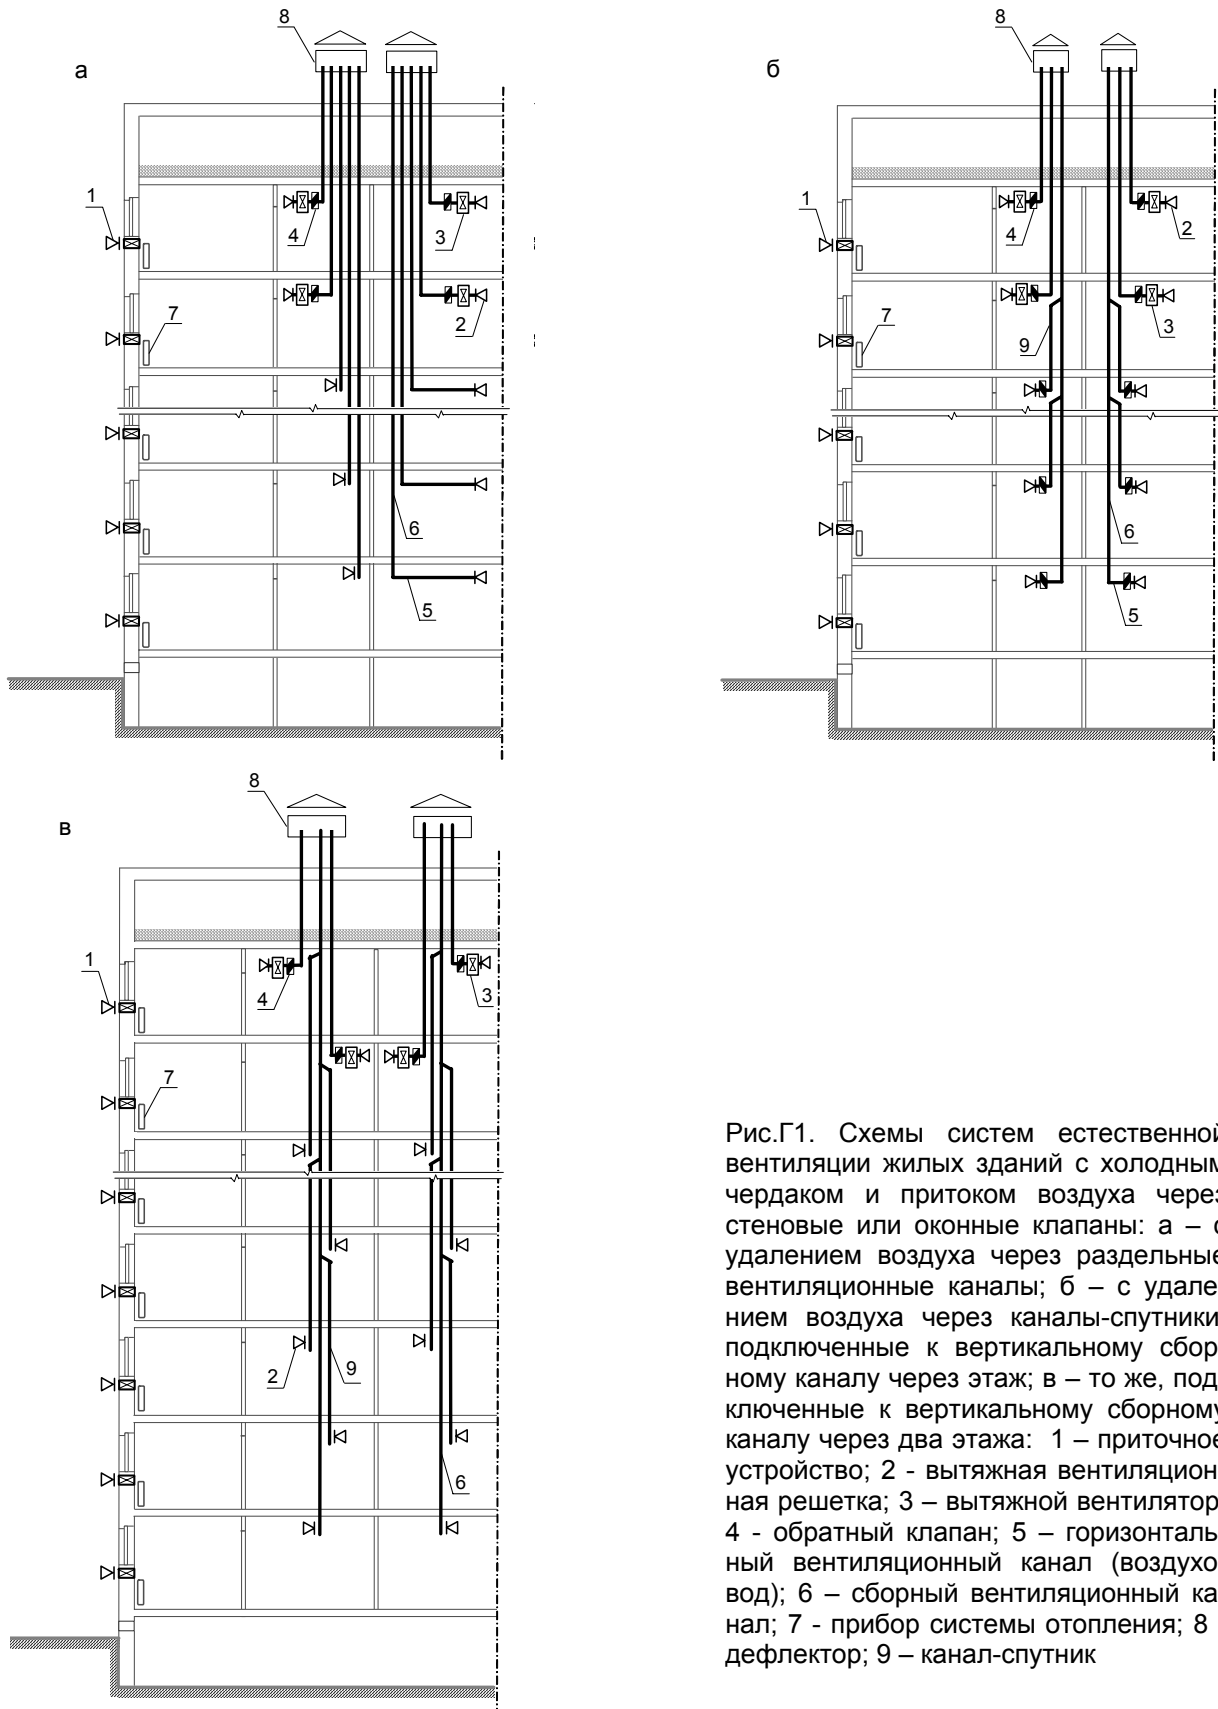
Схемы систем естественной вентиляции жилых зданий с холодным чердаком и притоком воздуха через стеновые или оконные клапаны: а – с удалением воздуха через отдельные вентиляционные каналы; б – с удалением воздуха через каналы-спутники, подключенные к вертикальному сборному каналу через этаж; в – то же, подключенные к вертикальному сборному каналу через два этажа: 1 – приточное устройство; 2 – вытяжная вентиляционная решетка; 3 – вытяжной вентилятор; 4 – обратный клапан; 5 – горизонтальный вентиляционный канал (воздуховод); 6 – сборный вентиляционный канал; 7 – прибор системы отопления; 8 – дефлектор; 9 – канал-спутник
